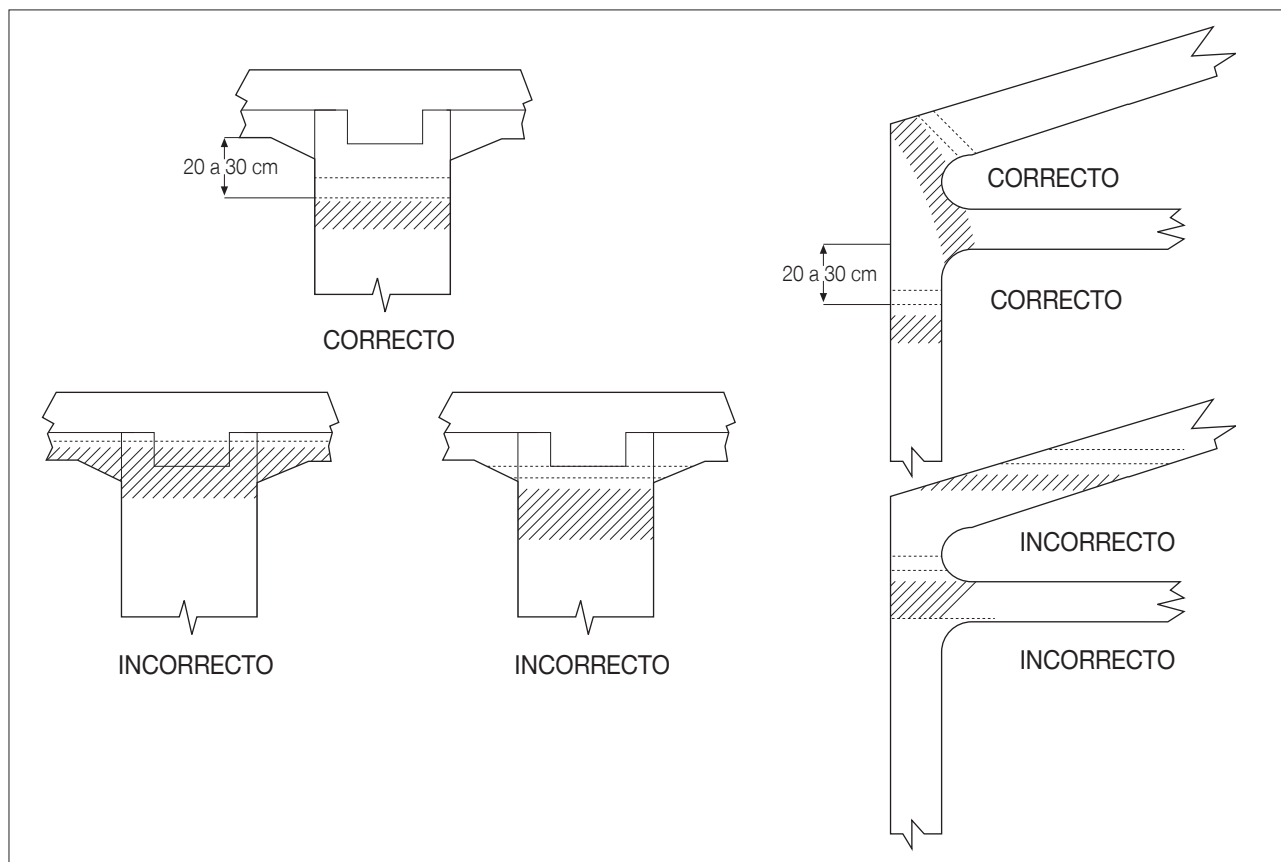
Ubicación de las Juntas de Hormigonado (NCh170.Of85)
